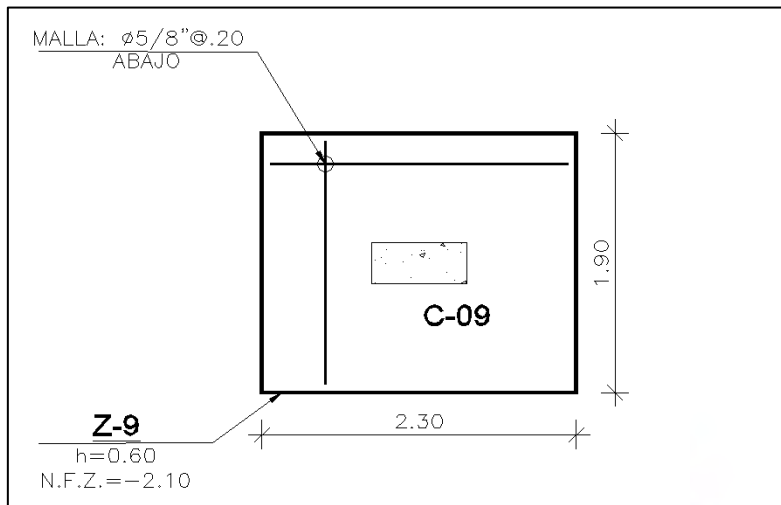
Diseño final de la zapata aislada Z-9.
